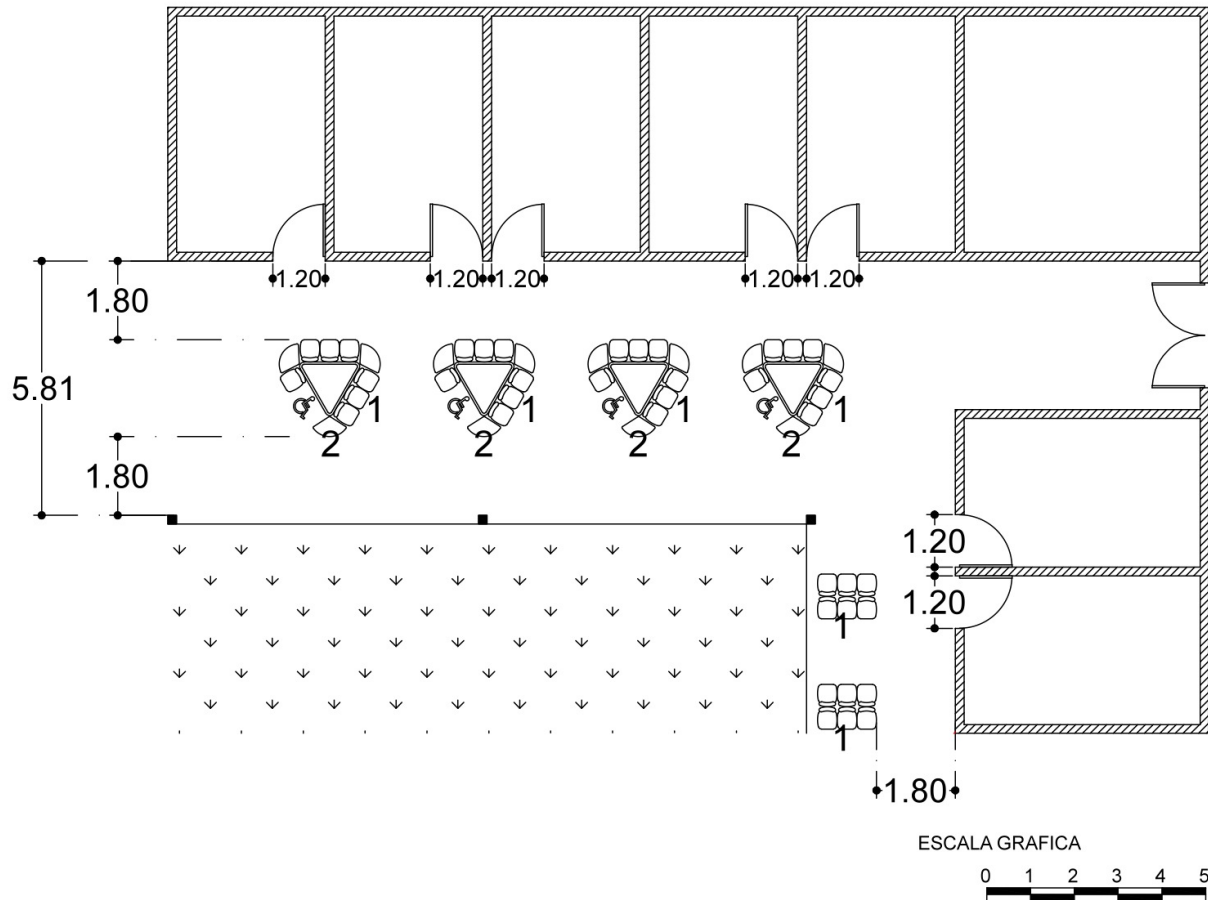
Planta arquitectónica de later sala de espera en el area de consulta externa.
